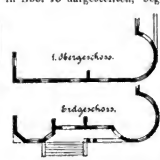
Fassade-Grundriss einer Cottage in Chicago.
